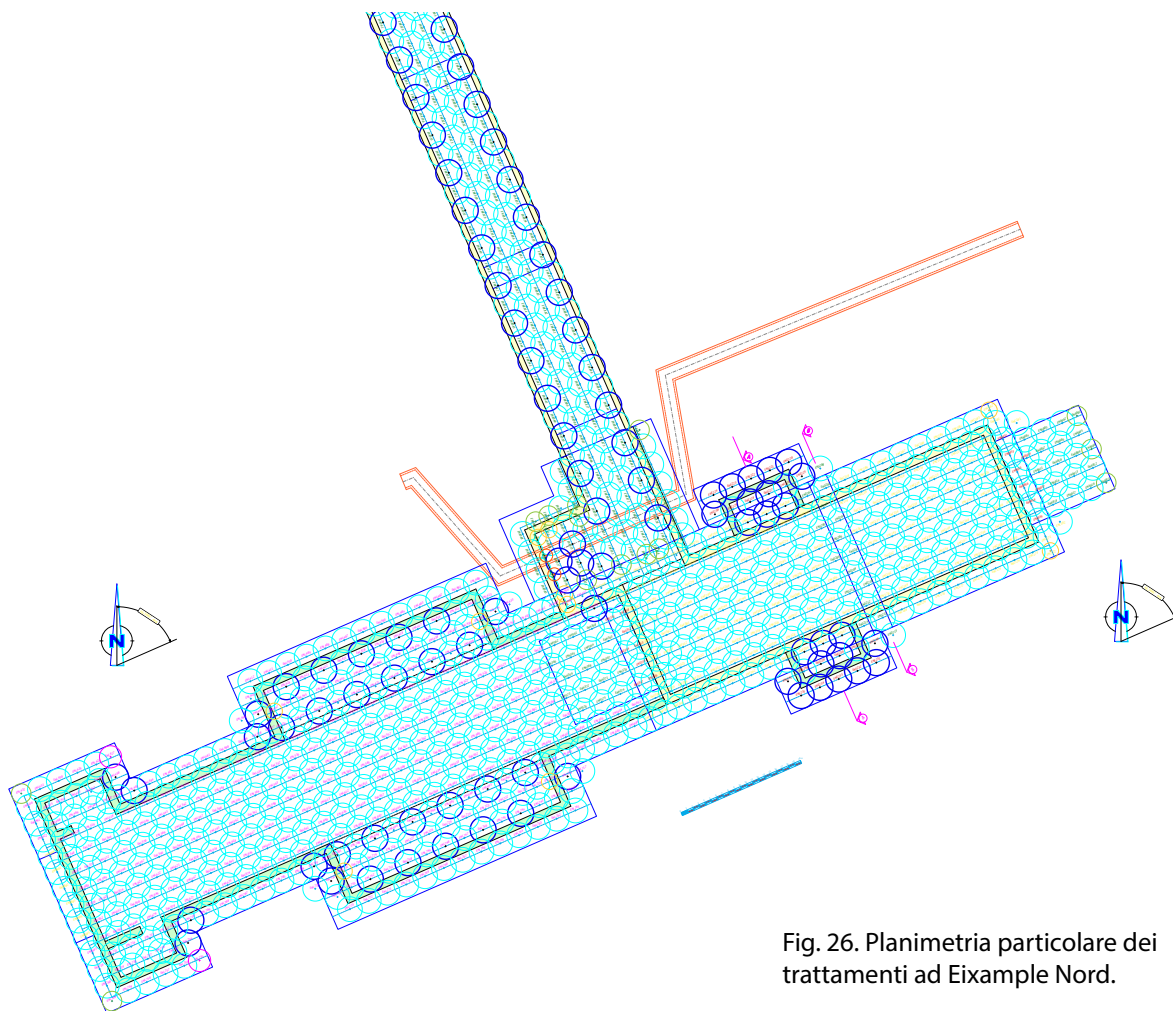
Planimetria particolare dei trattamenti ad Eixample Nord.
